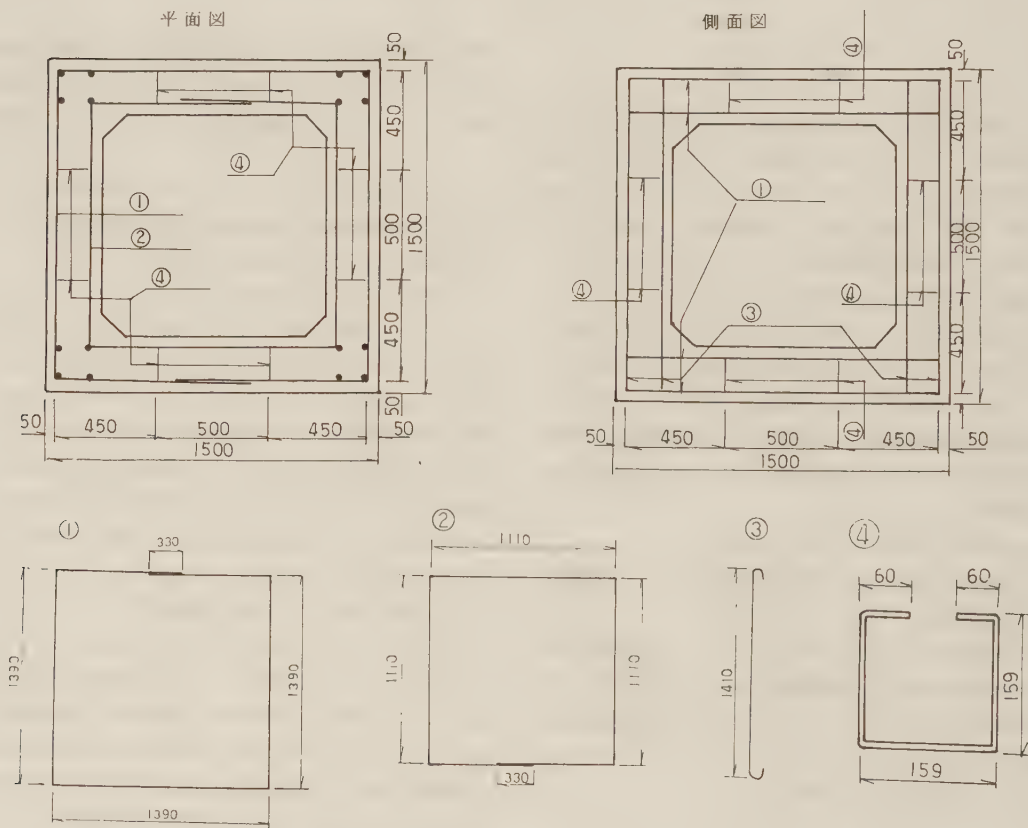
1.5 m 角型中空四角礁ブロック配筋図 (単位 ; mm)
